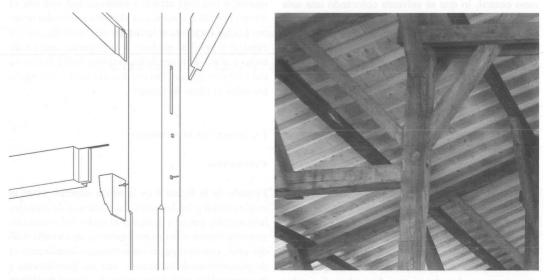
Nudo de unión entre correa lateral y apoyo de madera en un estado previo a su restauración y su estado actual (dibujo y foto del autor 2011)
